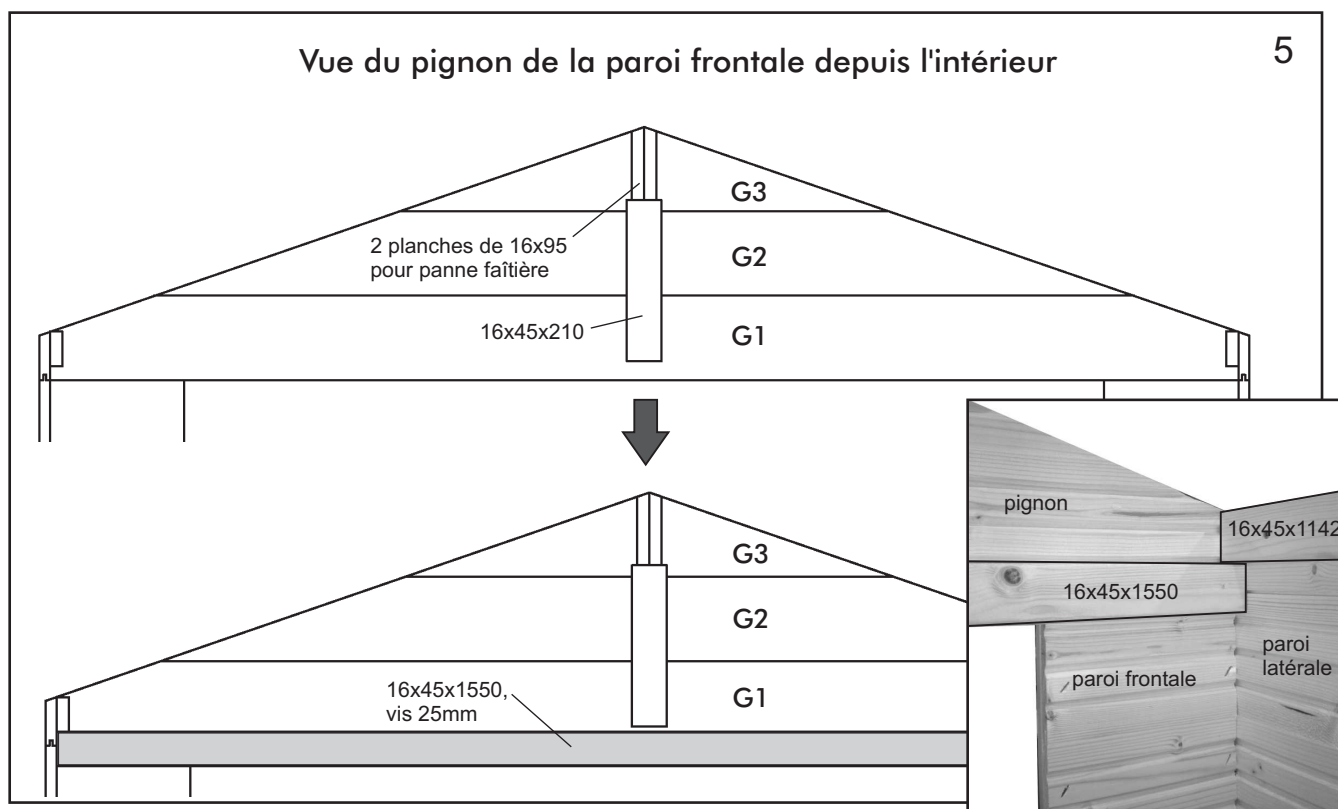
Avant d'installer la tranche supérieure des planches de parois latérales, mettez-les en place et sciez à la hauteur exacte selon le bord supérieur du pignon en suivant le dessin. Ensuite installez les lames de 16x45x1142mm aux parois latérales exactement à la hauteur du bord supérieur de la planche de rive de pignon et fixez les lames à la tranche supérieure des planches de paroi latérale en utilisant des vis (vis de 25 mm, 4 pces.). Plus tard, les planches du toit seront clouées sur ces lames.
